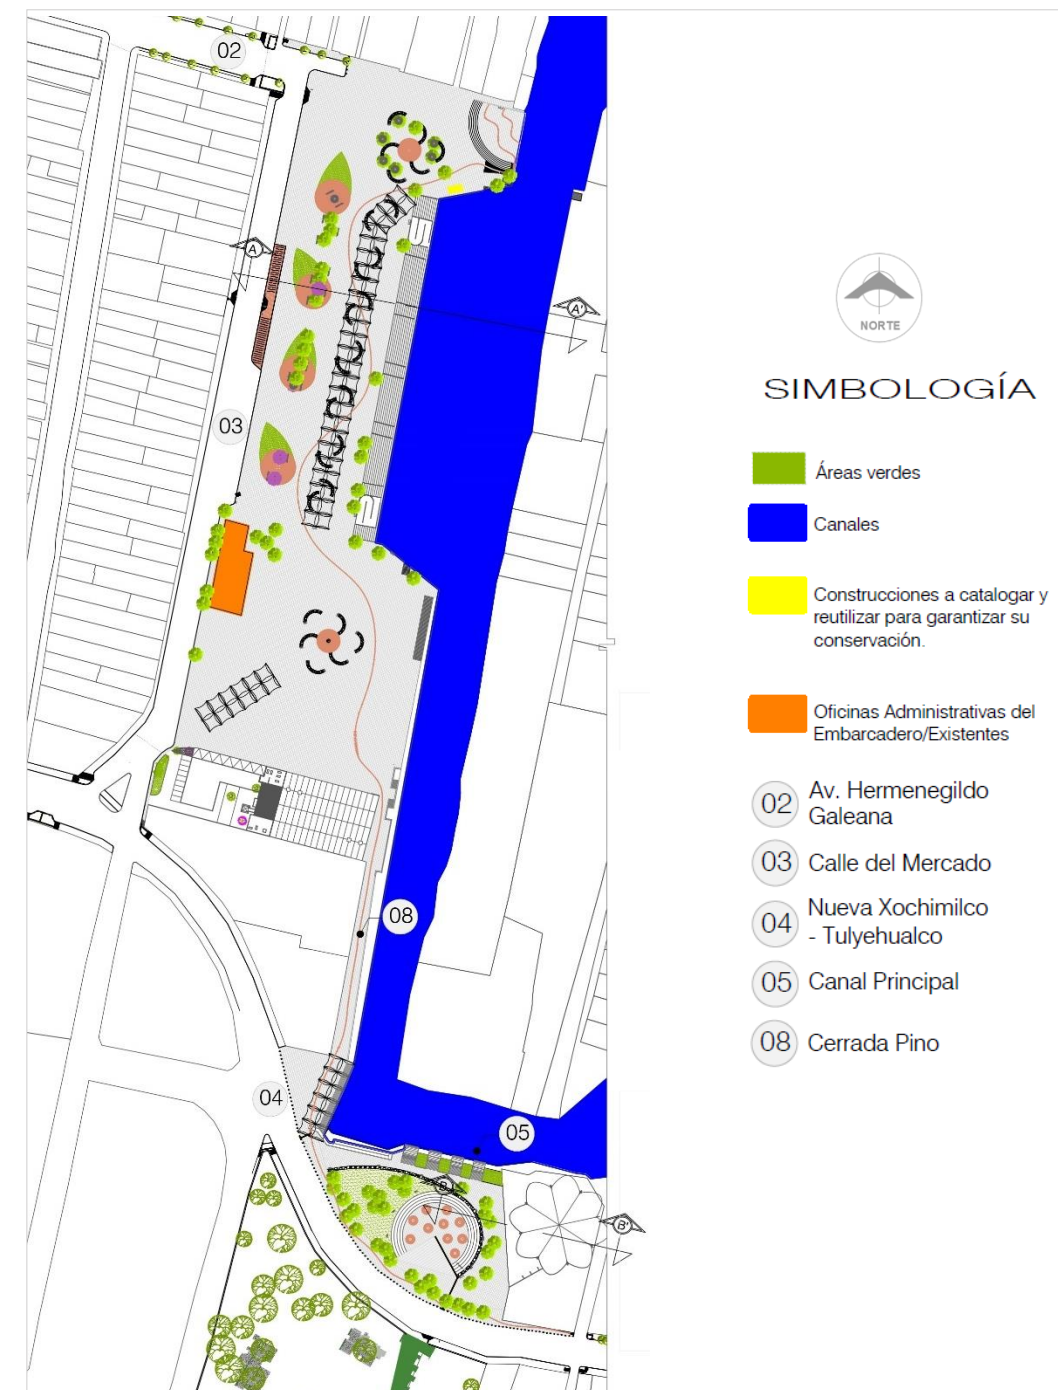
Planta de conjunto / Propuesta urbana (Elaboración propia).
